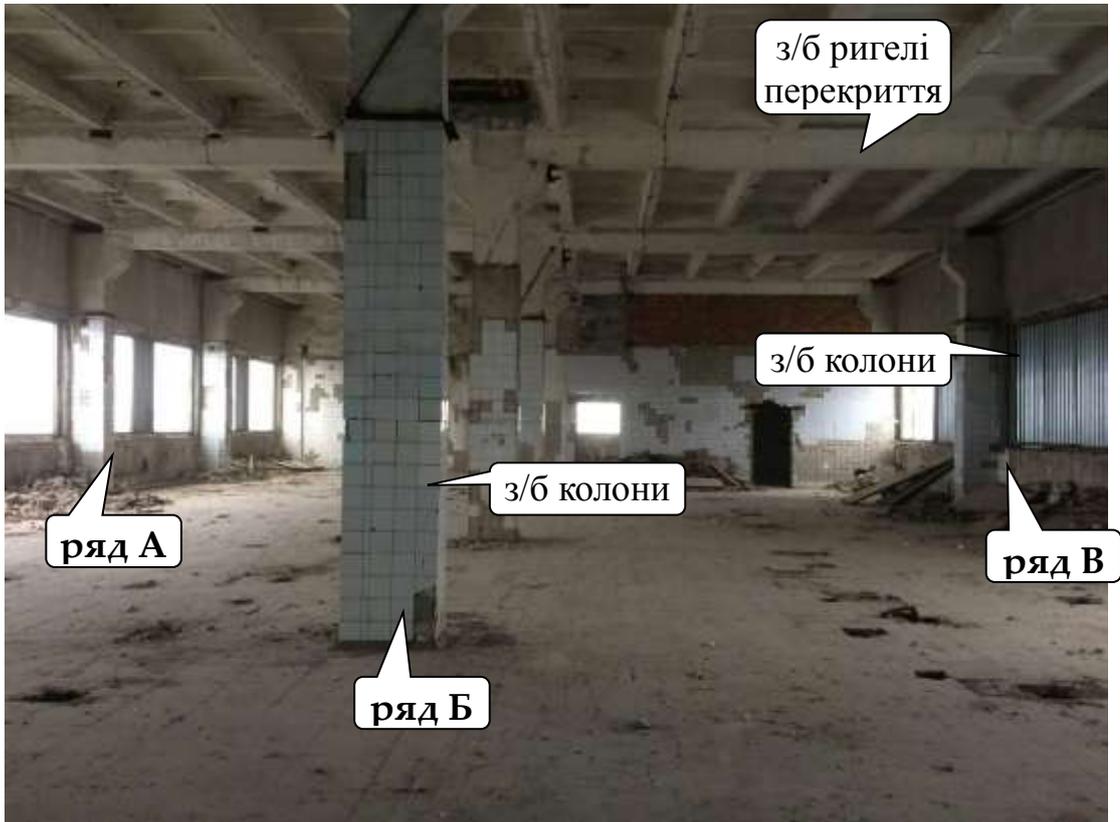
Схема розташування несучих конструкцій на плані типового поверху промислової будівлі до її реконструкції
